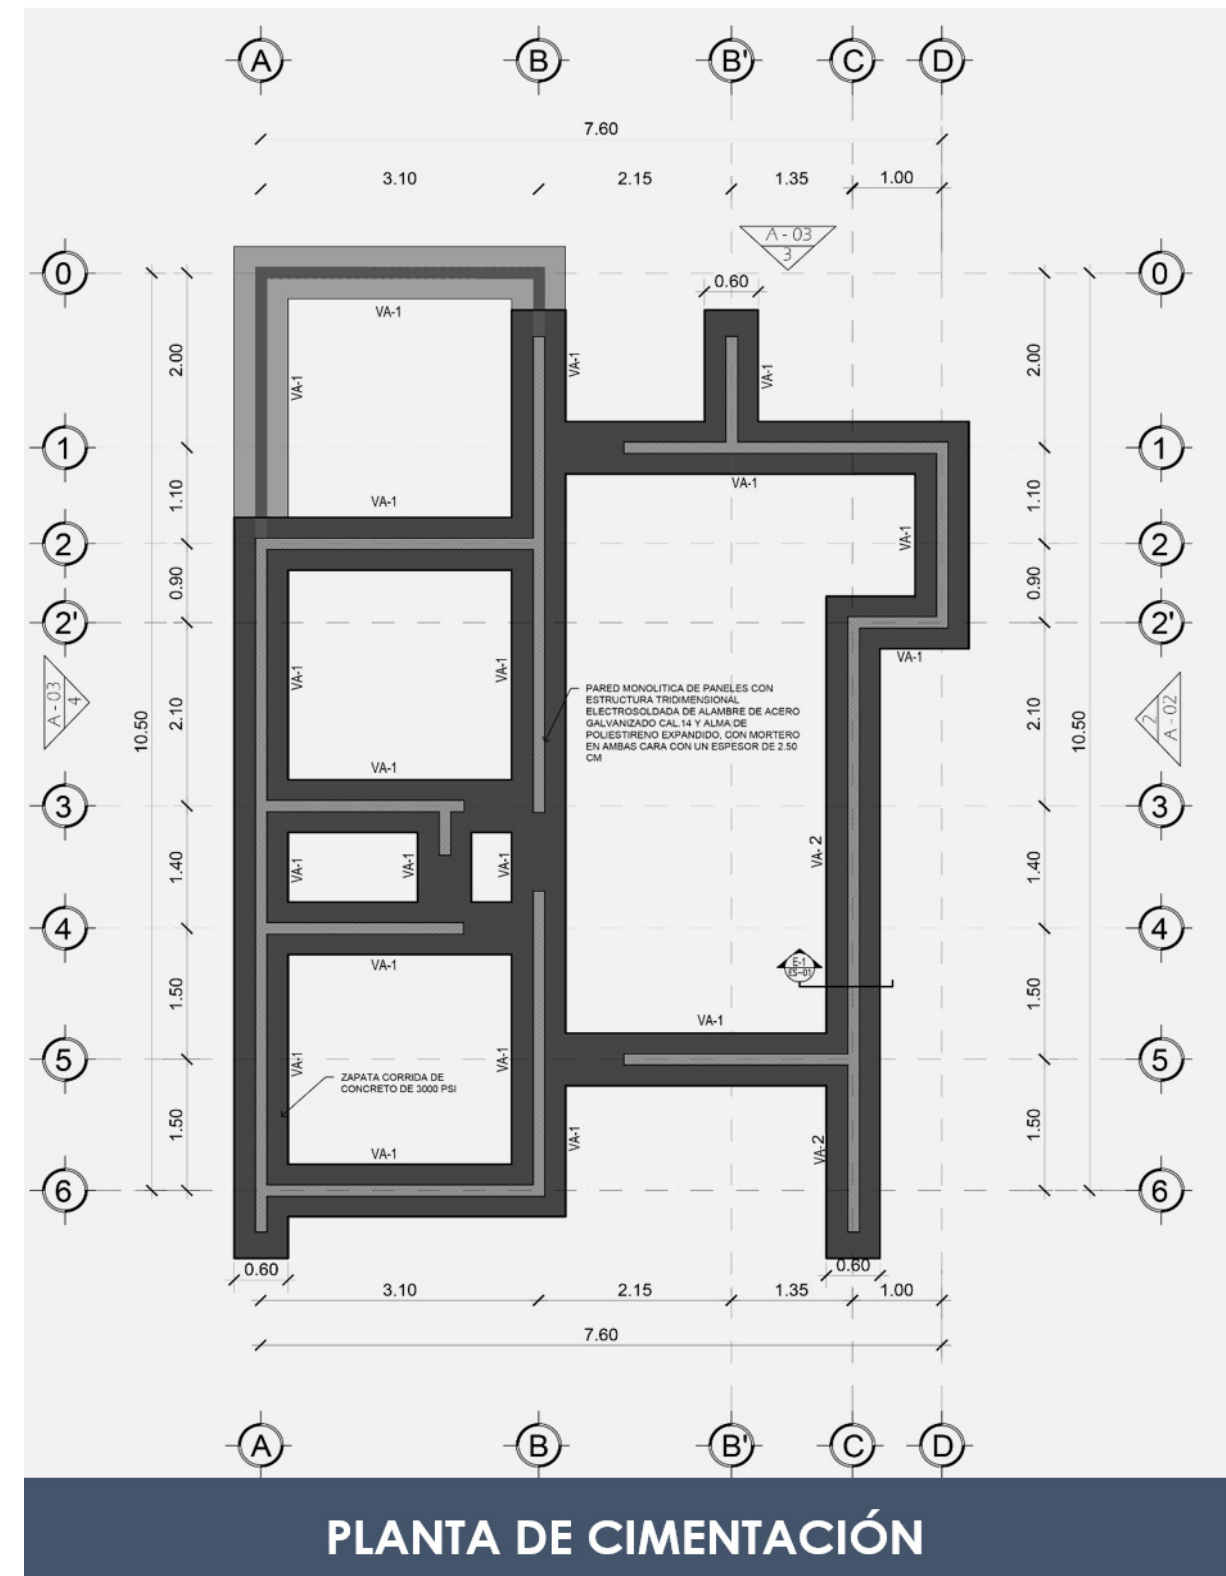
Detalle de Cimentación Vivienda Félix Fuente: Propia
